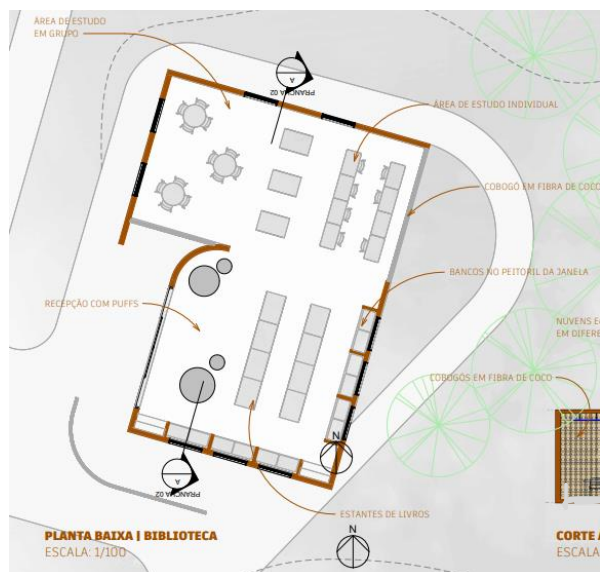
Planta Baixa da Biblioteca (Autores, 2023)
